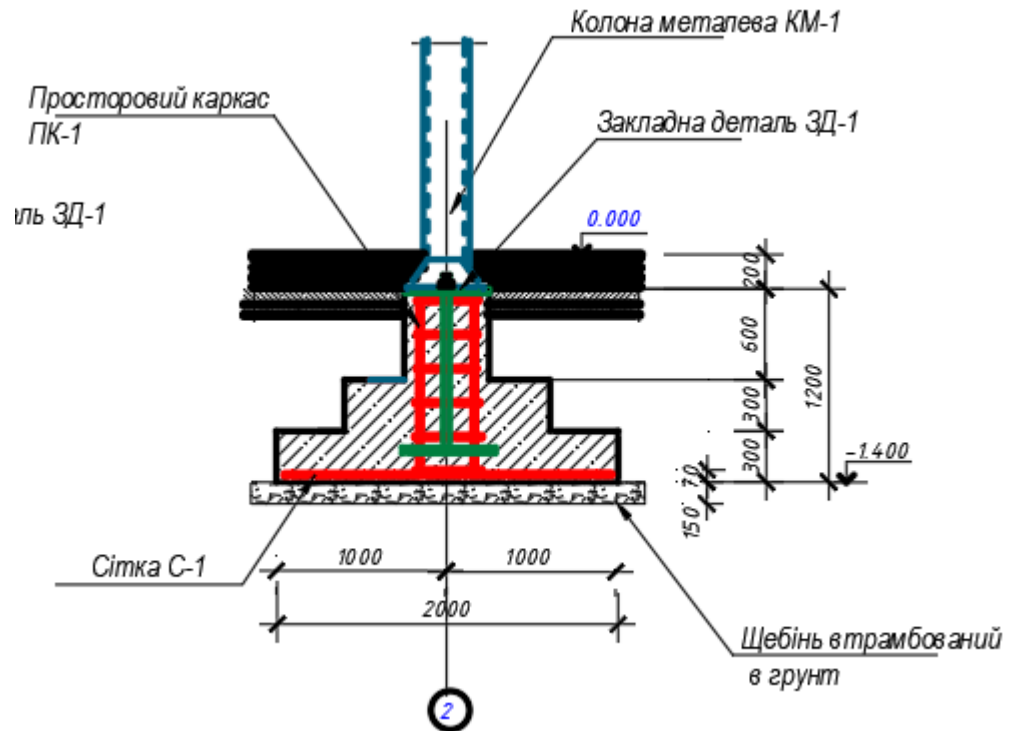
Конструкція фундаменту під колону середнього ряду
